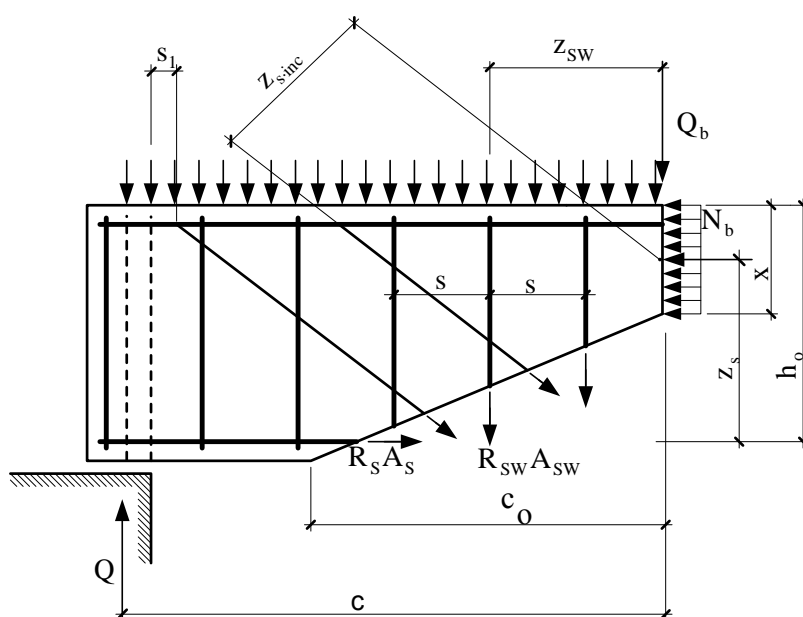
Расчетная схема усилий в наклонном сечении.
